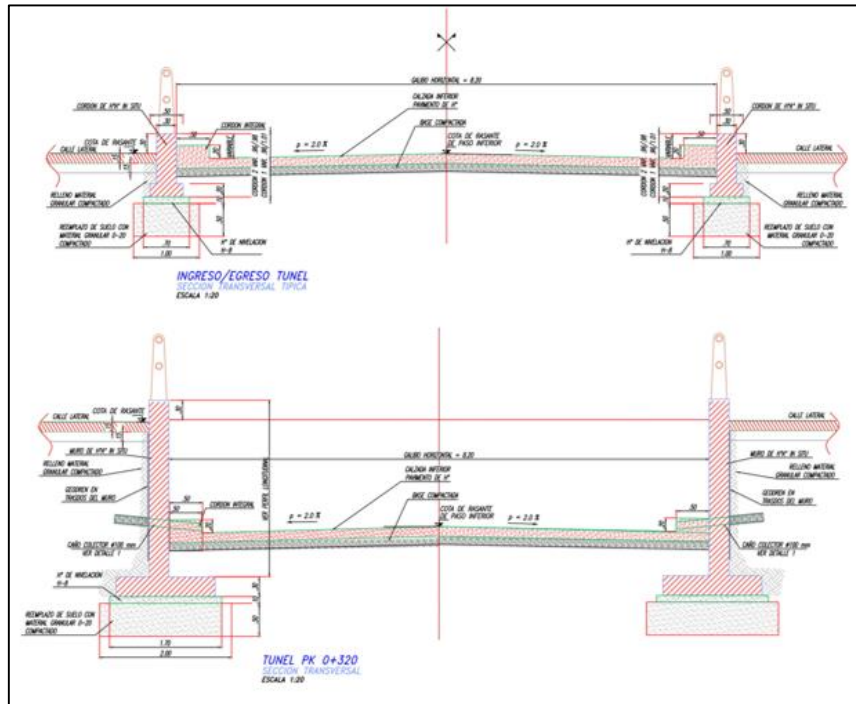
Sección transversal del viaducto en zona de cordón y muros. (PLANO N° 4)
